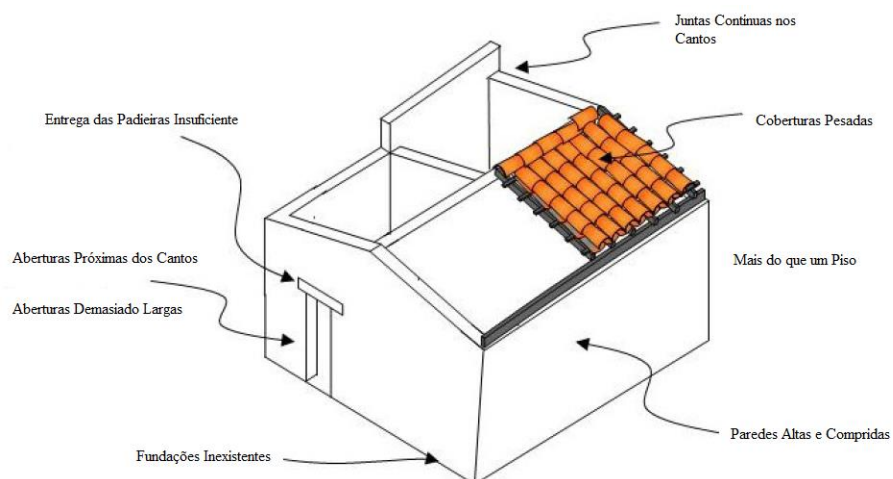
Erros correntes em construções de adobe (Peña – 2008)
